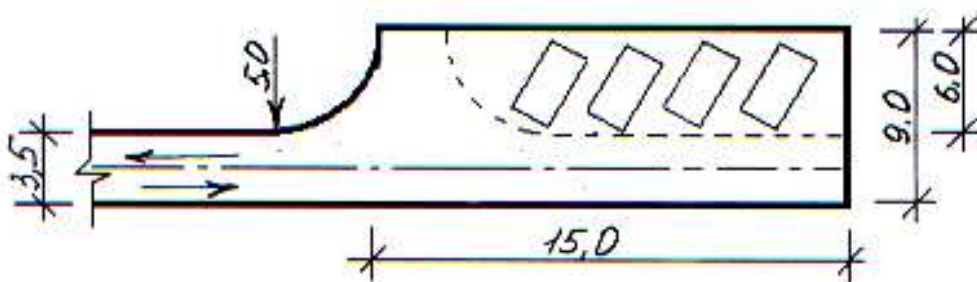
Планировочные схемы поворотных и разворотных площадок на внутриквартальных проездах (начало)
